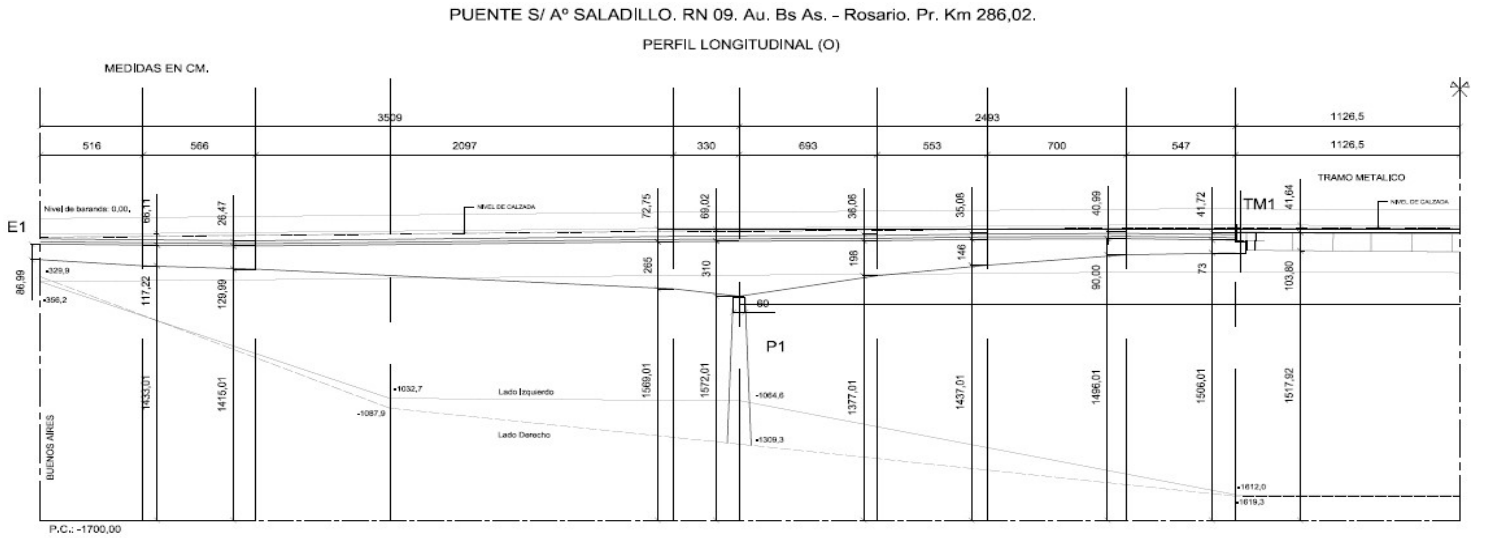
10. Perfil longitudinal del puente sobre el Rio Saladillo desde el estribo hasta la primera unión con el tramo metálico.
